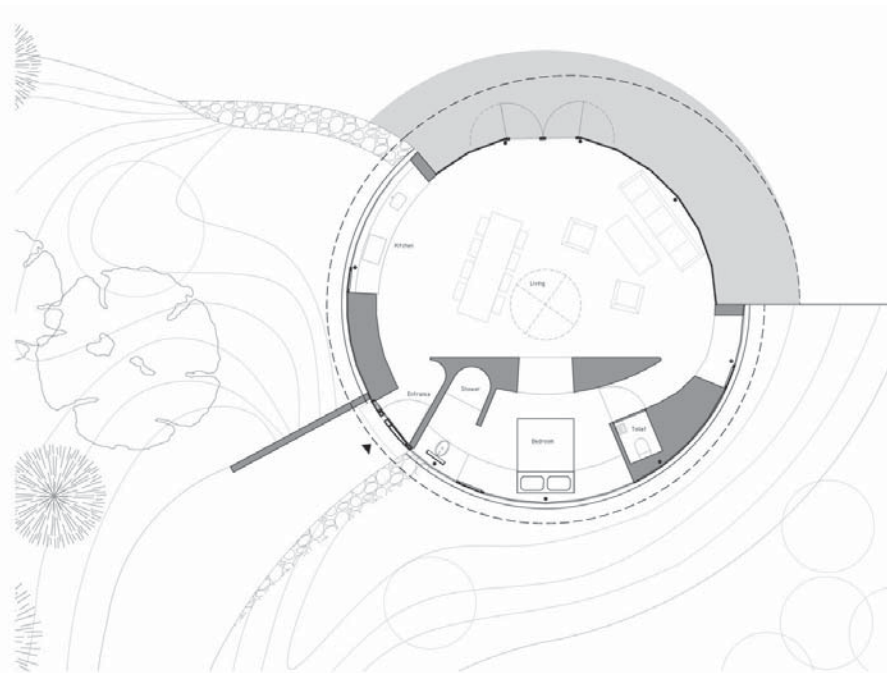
Planta arquitectónica de la Villa 360. Archdaily.com
